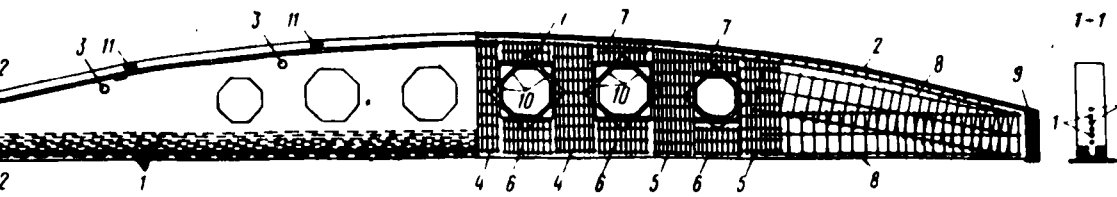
Балка АНБЭ-18-4 с электротермическим натяжением стержневой арматуры
